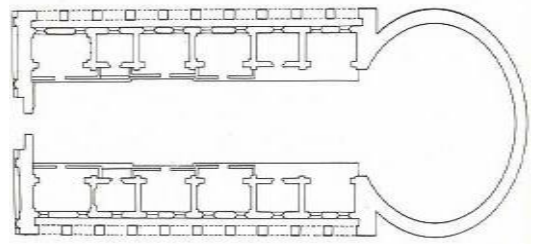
Brunelleschi. Palazzo Pitti.
